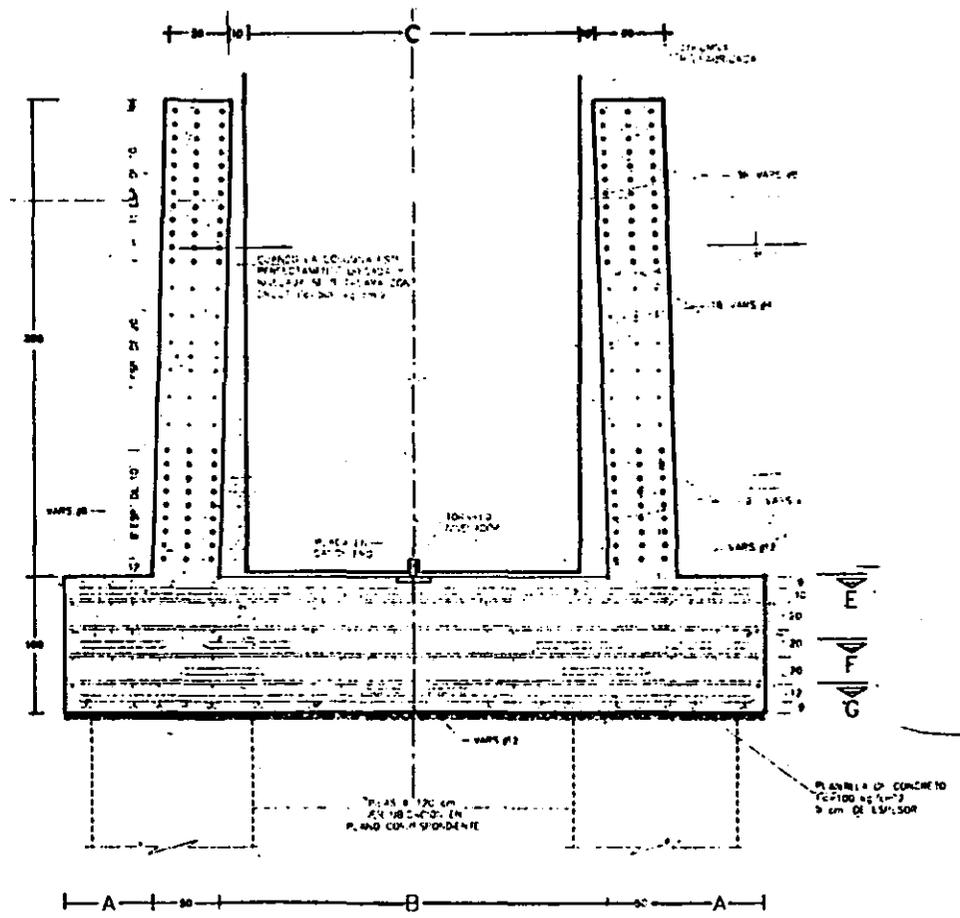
C(1). Corte Transversal de Zapata de cimentación.
